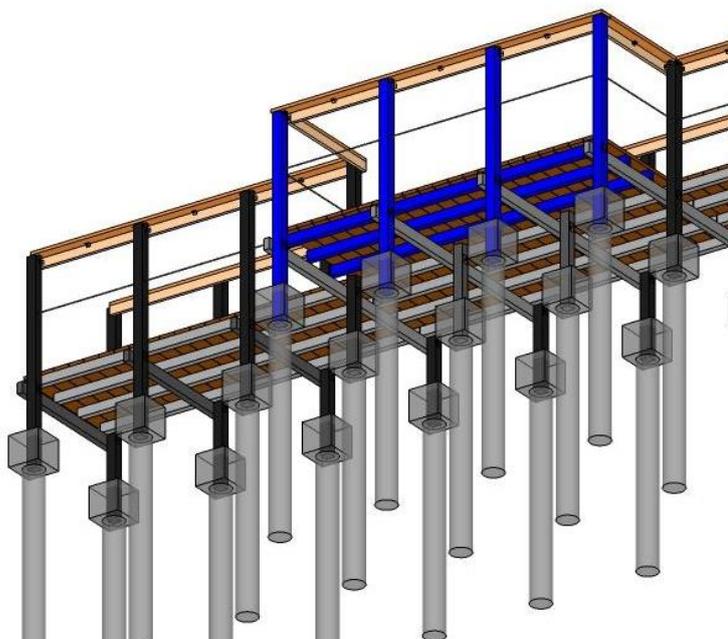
Vista de baixo da estrutura da trilha em um ponto de ultrapassagem com destaque em azul para os pilares e barrotes do ponto de ultrapassagem.
